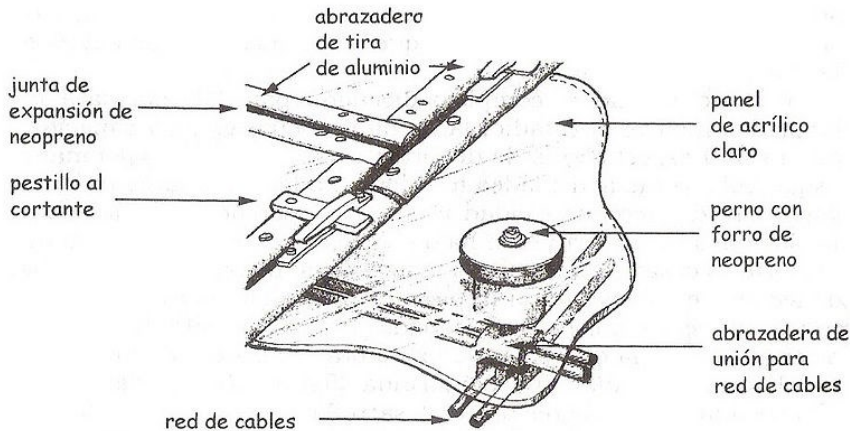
Detalle axonométrico de uniones para la cubierta.
